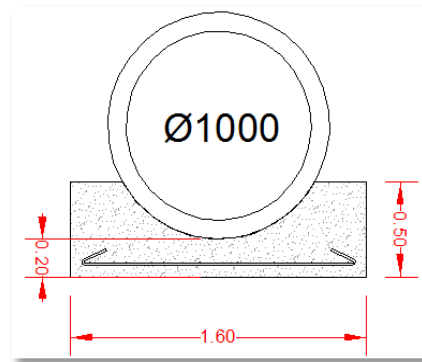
Coupe type canalisation avec lit de pose en béton armé
